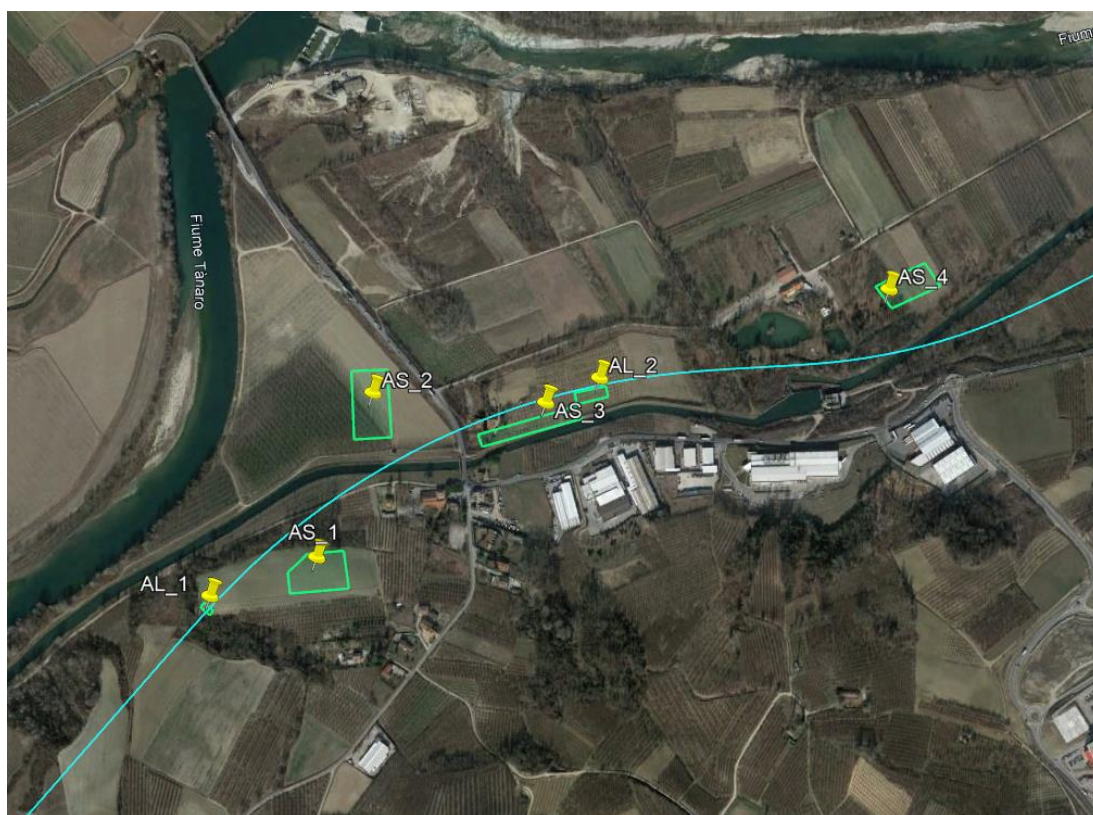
Rappresentazione aree di cantiere – Scenario 1 (in celeste l'asse stradale di progetto)
